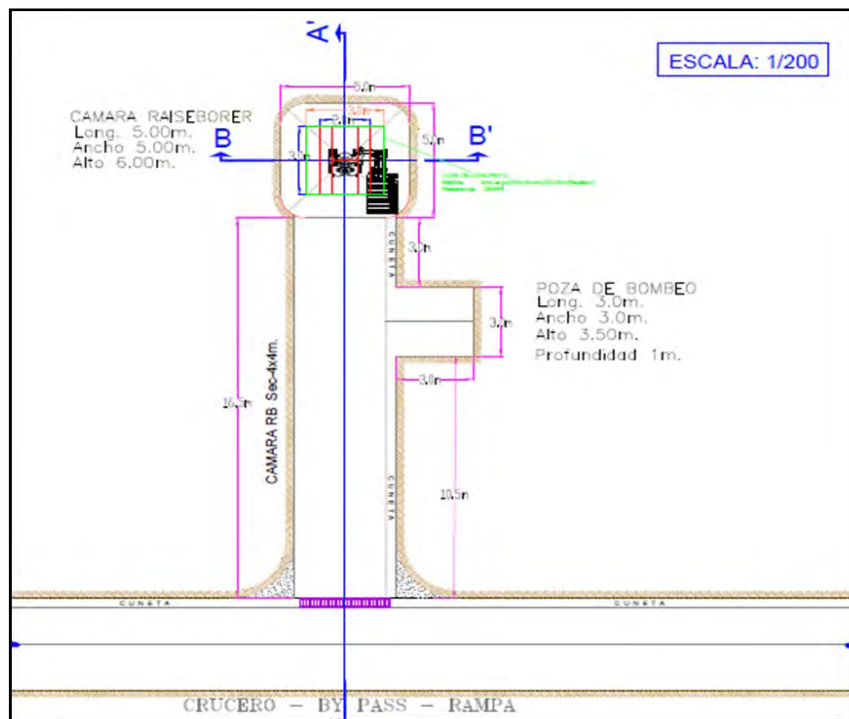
Sección vista en planta de cm Raise Boring proyecto CM RB 650
